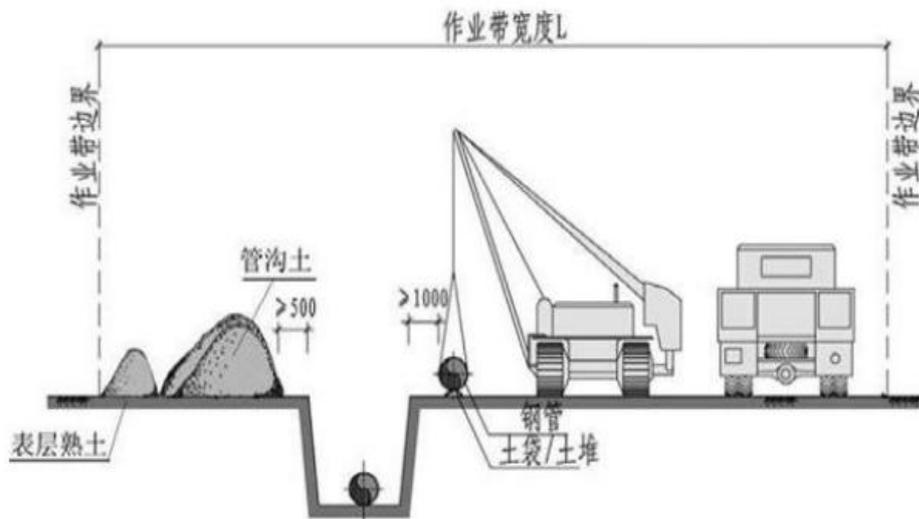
管沟开挖施工工艺及管道施工作业带断面示意图
